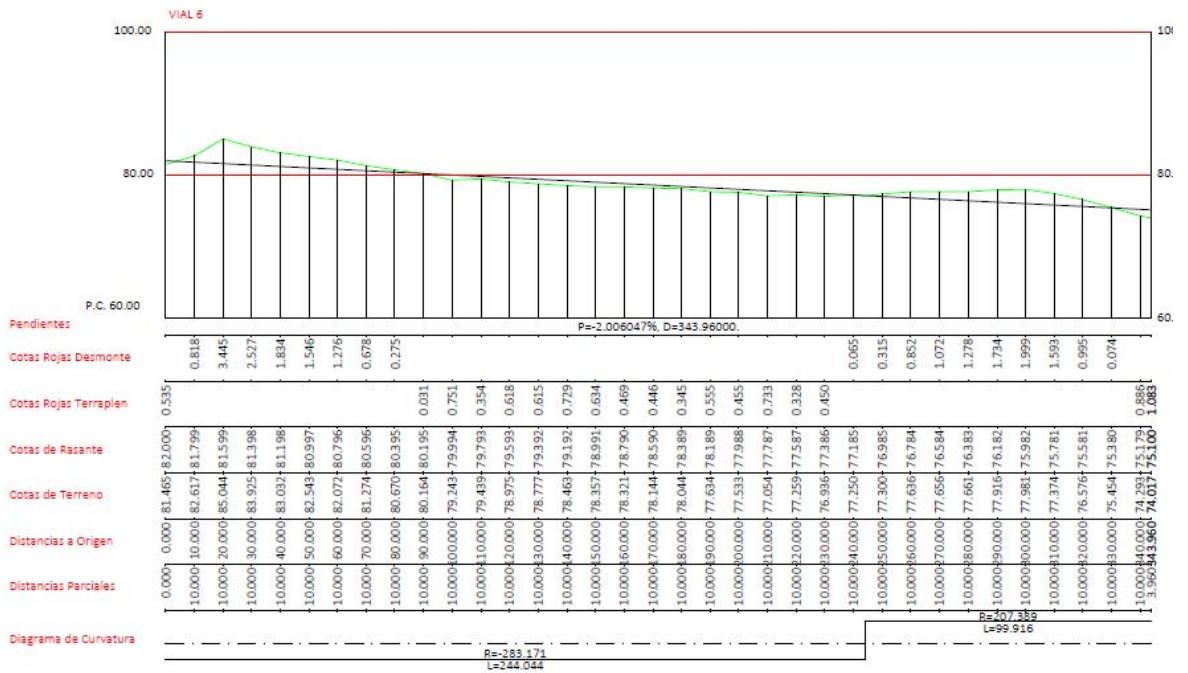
Imagen de la sección longitudinal del vial 6 en la alternativa 2.
